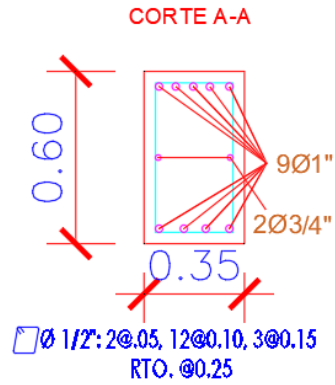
Secciones de Viga con Refuerzo 2° Piso
